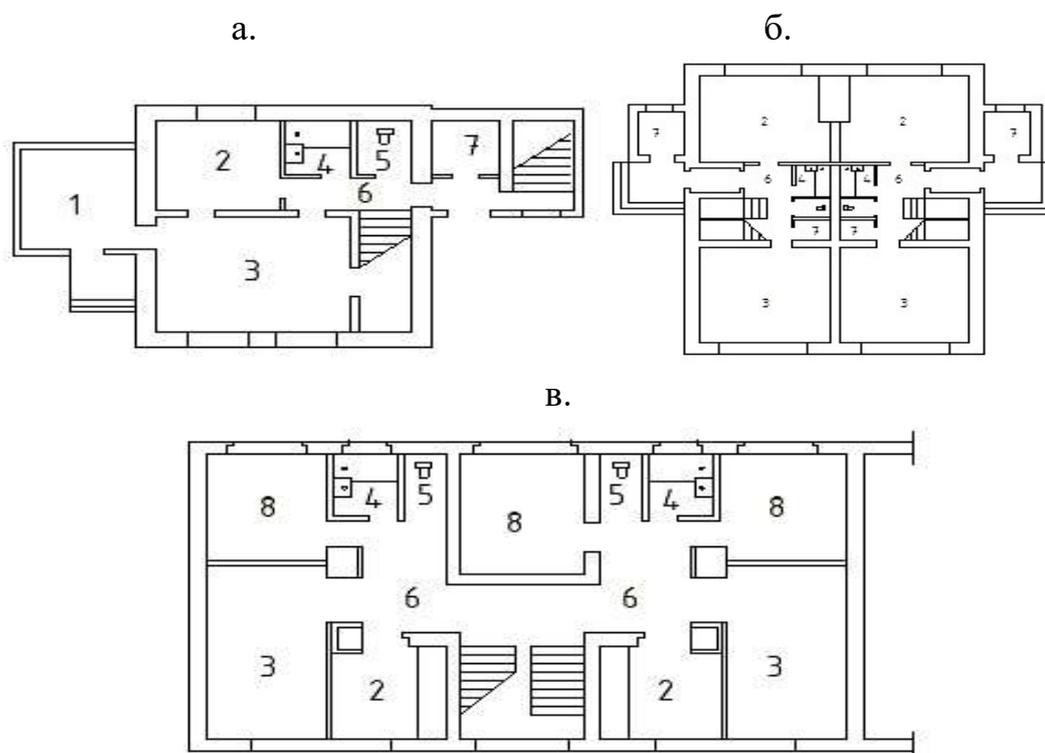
Схемы объемно-планировочных решений малоэтажных жилых домов: а – одно- и двухэтажных одноквартирных и блокированных; б – секционных; 1 – веранда; 2 – кухня; 3 – общая комната; 4 – ванная; 5 – санузел; 6 – передняя; 7 – кладовая; 8 – спальня
